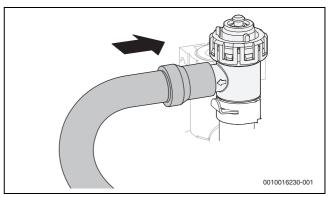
Montaggio del tubo flessibile alla valvola di sicurezza
